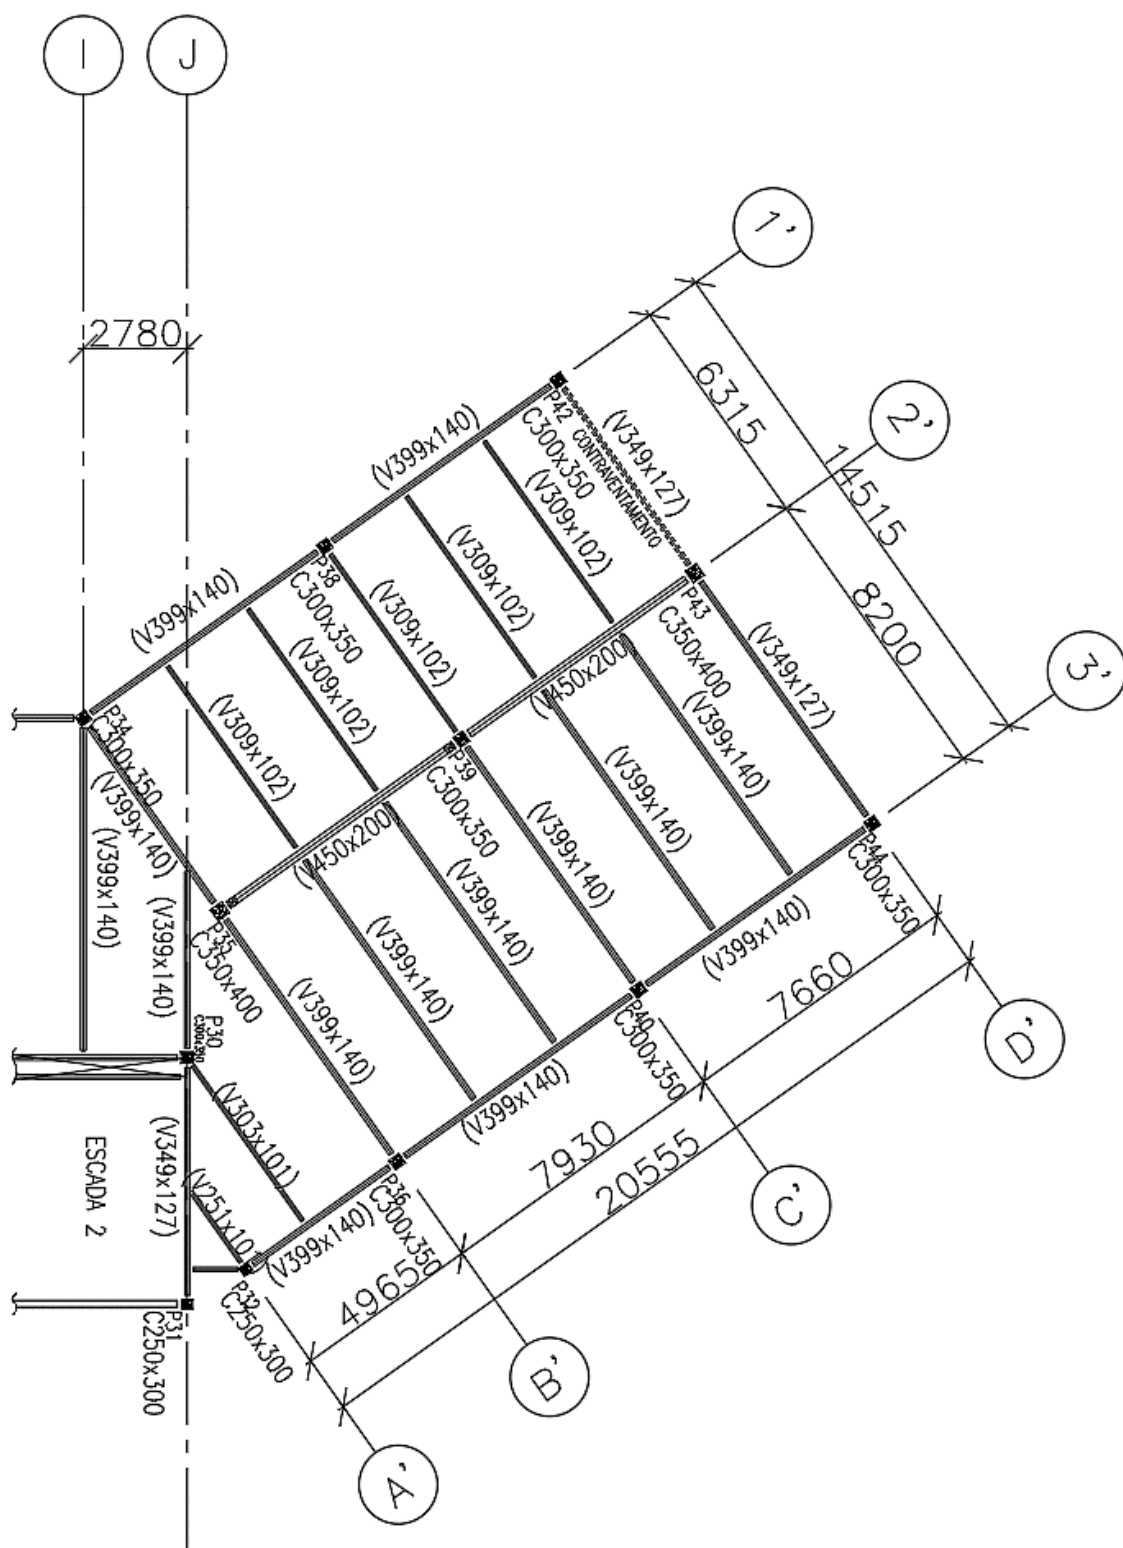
Dimensões e seções transversais dos perfis do Lado B (cotas em mm).
